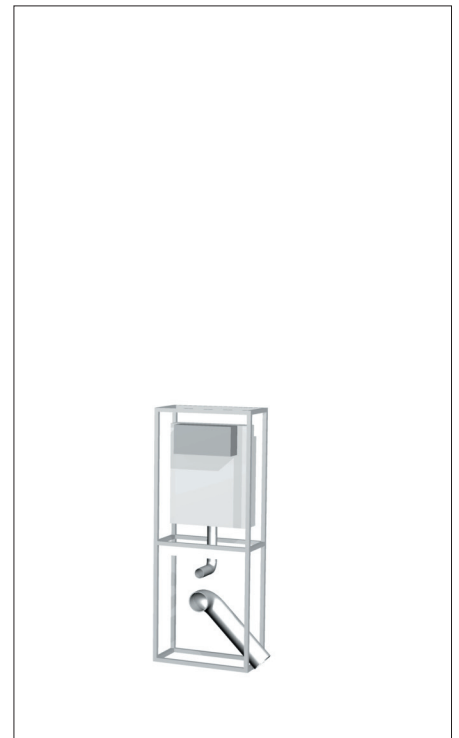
Beim offenen Installationsblock sind alle für das Element benötigten Rohrleitungen und Sanitärkomponenten in einem selbsttragenden Rahmengerüst fertig montiert. Es beinhaltet auch die erforderlichen Halterungen für die Sanitärgegenstände. Das Gestell wird auf der Baustelle verfüllt und verkleidet. Verwendet wird der Installationsblock vor allem als Unterbau und Installationsmodul für WC, Bidet und Waschbecken sowie für die vertikale Wasser- und Abwasserführung. Der Austausch einzelner Leitungen und die Einbringung von zusätzlichen Anschlüssen und Leitungen ist aufgrund der spezialisierten und kompakten Bauweise nur schwer möglich. Dennoch können die einzelnen Module individuell nach Kundenwunsch sogar noch auf der Baustelle zusammengestellt und miteinander verbunden werden. Der Installationsblock kann sowohl im Neubau wie auch bei Sanierungen eingesetzt werden. Die Wirtschaftlichkeit ist sehr hoch, da die Kombination aus Leitungen, Sanitärkomponenten und Montagegestell viel Zeit spart und die einzelnen Module in großer Stückzahl im Werk gefertigt werden können.
